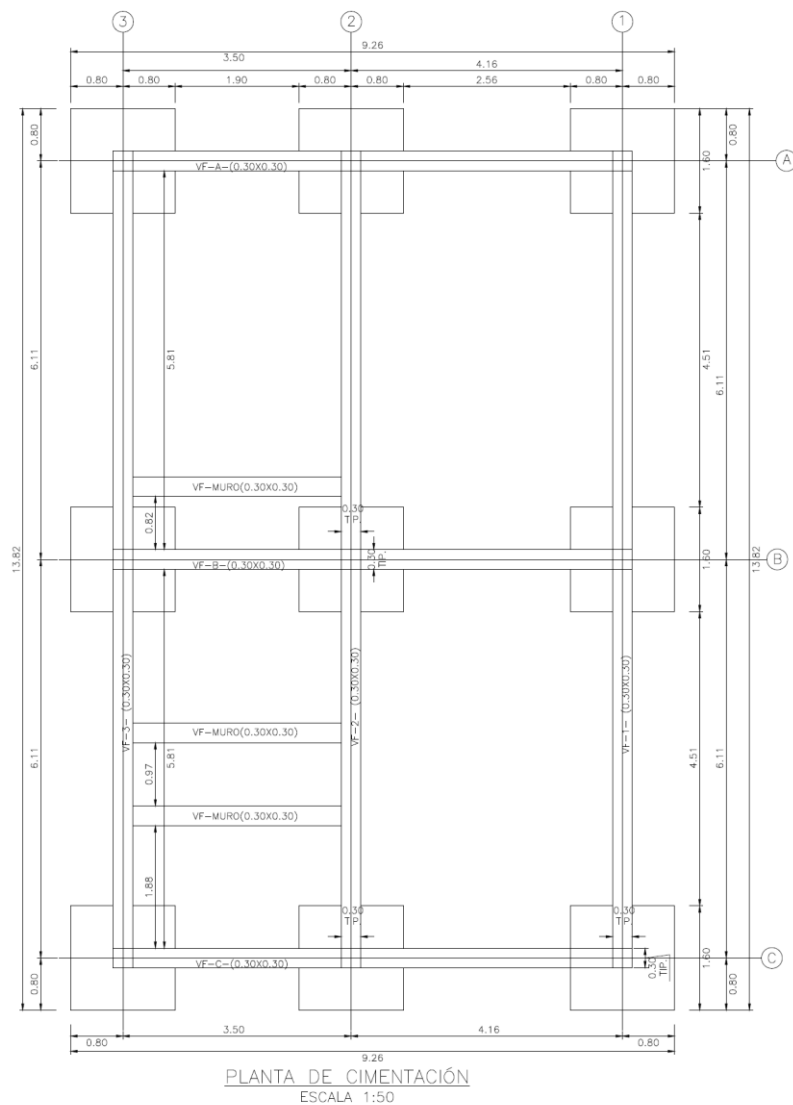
Cimentación Caseta de control sección tipo vigas de amarre y zapatas (disposición, dimensión y cantidad deberán ser justificadas en el diseño de detalle).
